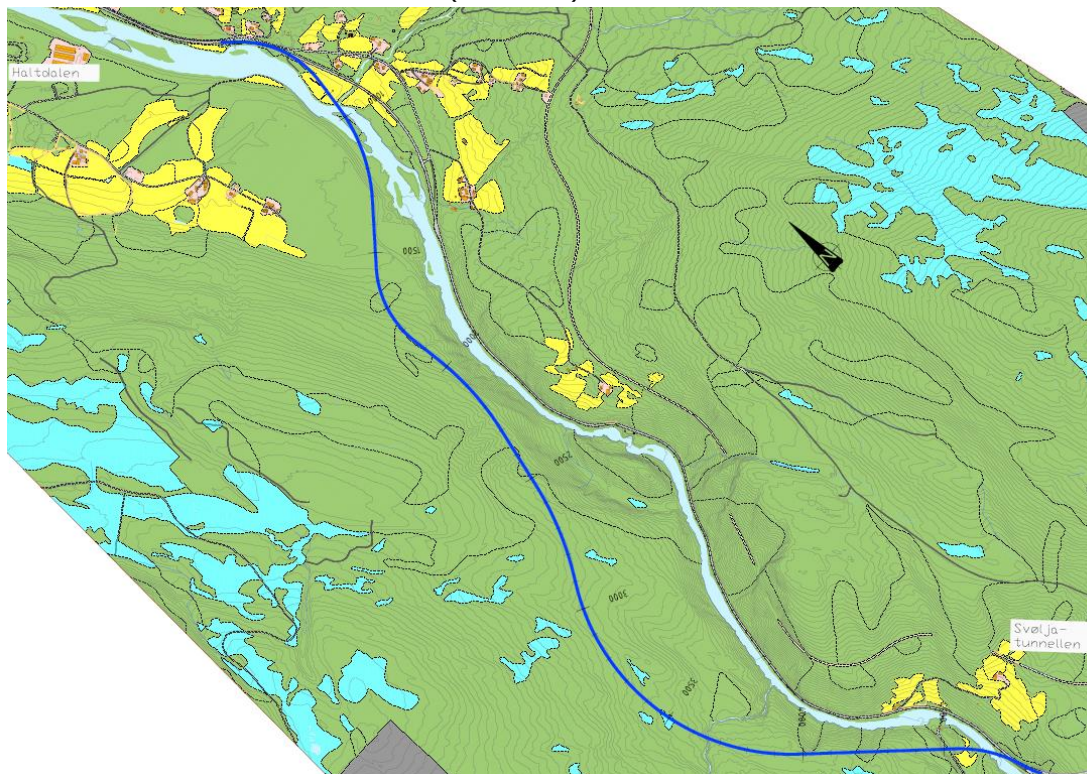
Alt. 2: Tunnel (2,4 km) på østsiden
